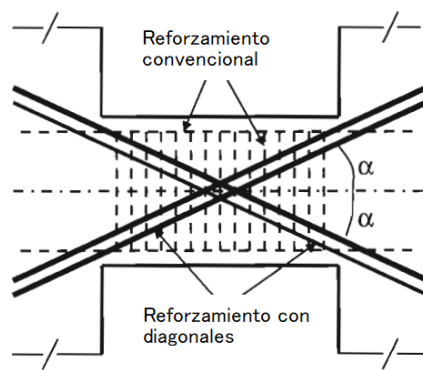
Tipos de reforzamientos en las vigas de acople.
